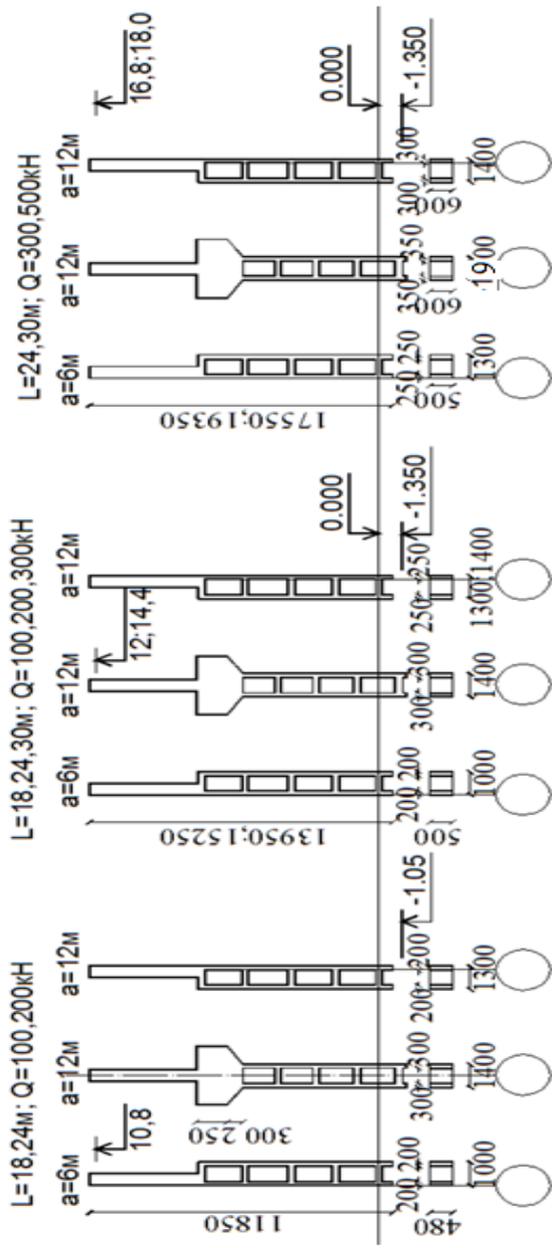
Железобетонные колонны двухветвевые для зданий с мостовыми кранами
